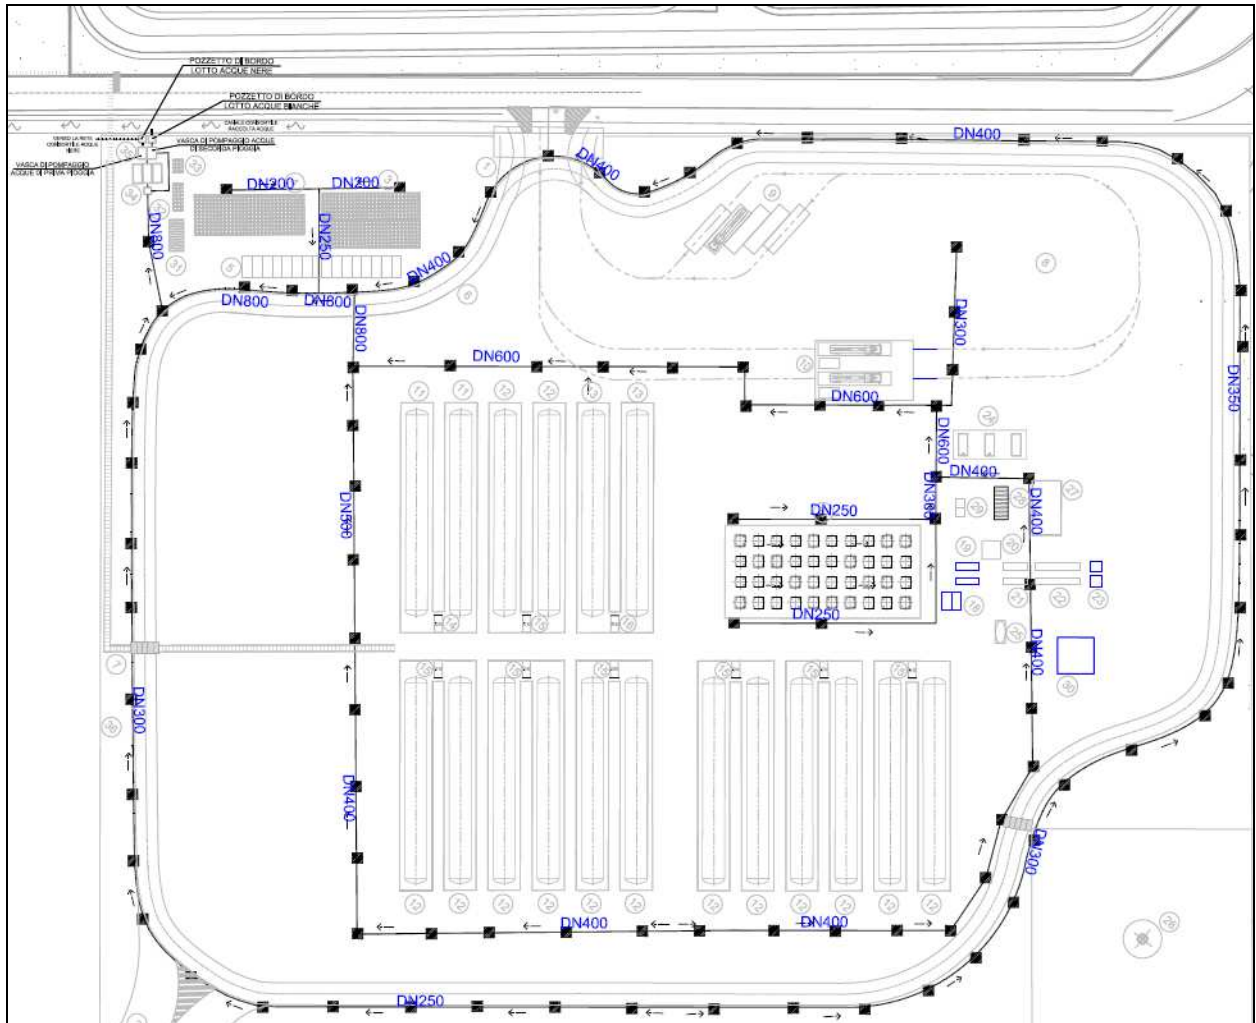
Planimetria rete di smaltimento acque meteoriche. Rif. Elab. D_05_UR_05_RAC_R00.
